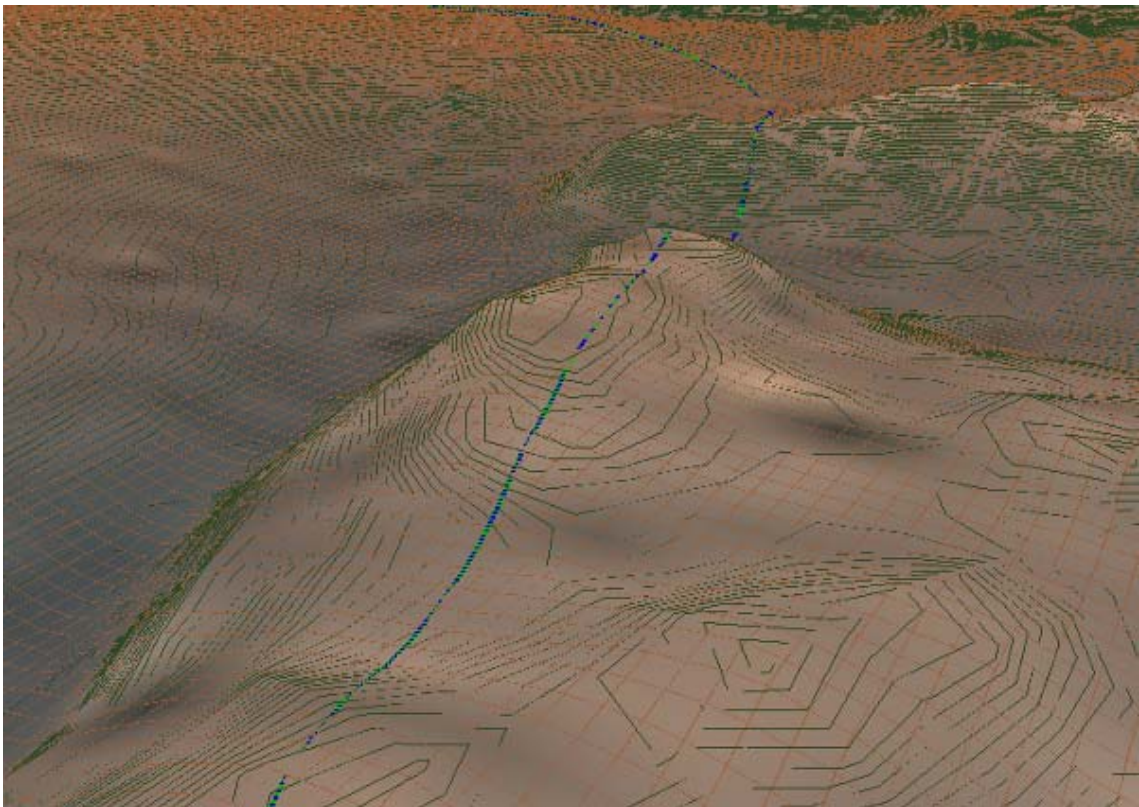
Configuração final apoiada – visão do planalto e vale – duto 8”
